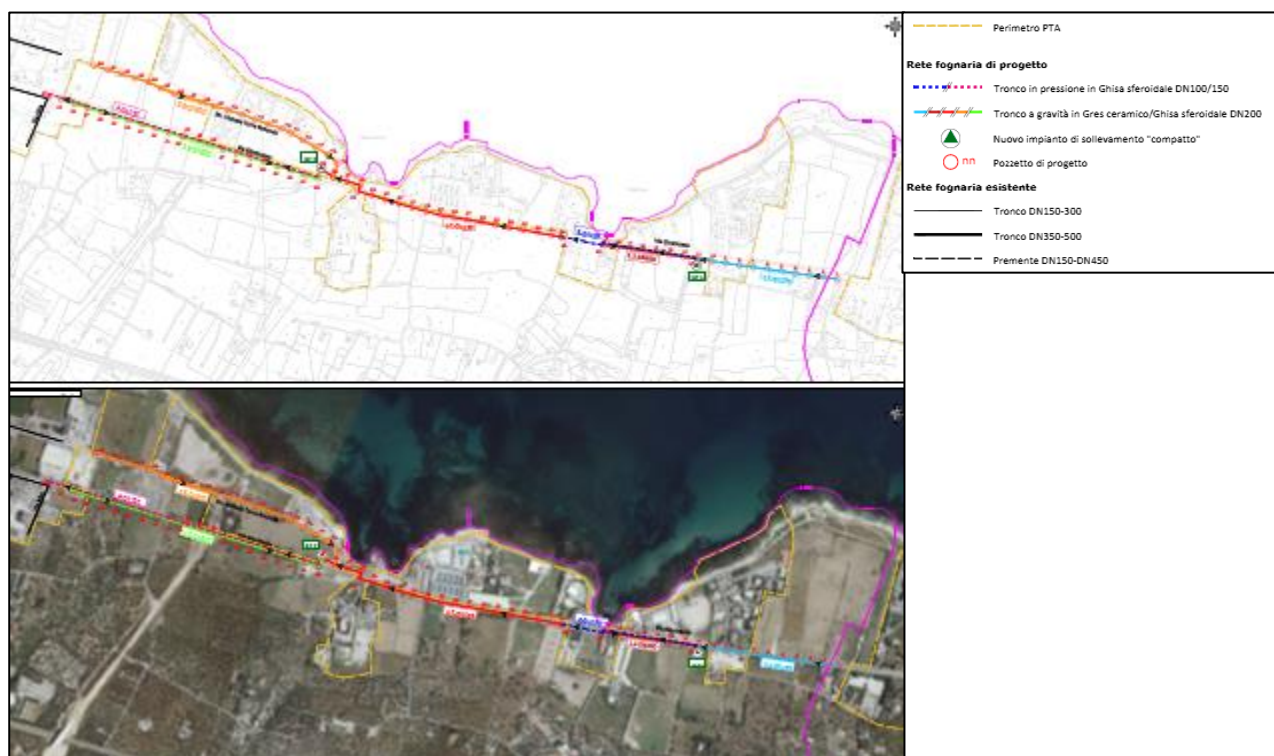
Stralcio della planimetria di progetto rete fognaria – Riviera Sud e Gavetone
